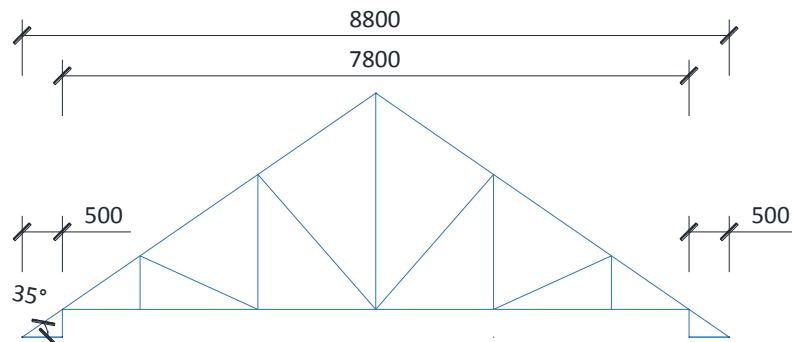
Pembebanan kuda-kuda 1 dan 9 denah A
